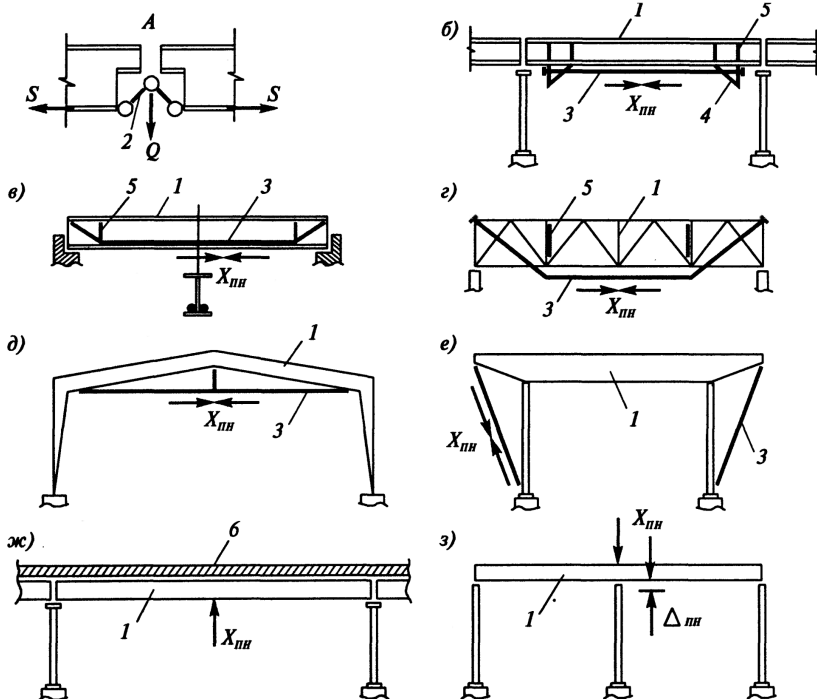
Усиление путем предварительного напряжения конструкций: 1 – усиливаемая конструкция; 2 – распорное устройство; 3 – предварительно натянутая высокопрочная затяжка; 4 – новый столик; 5 – детали местного усиления; 6 – плиты настила
